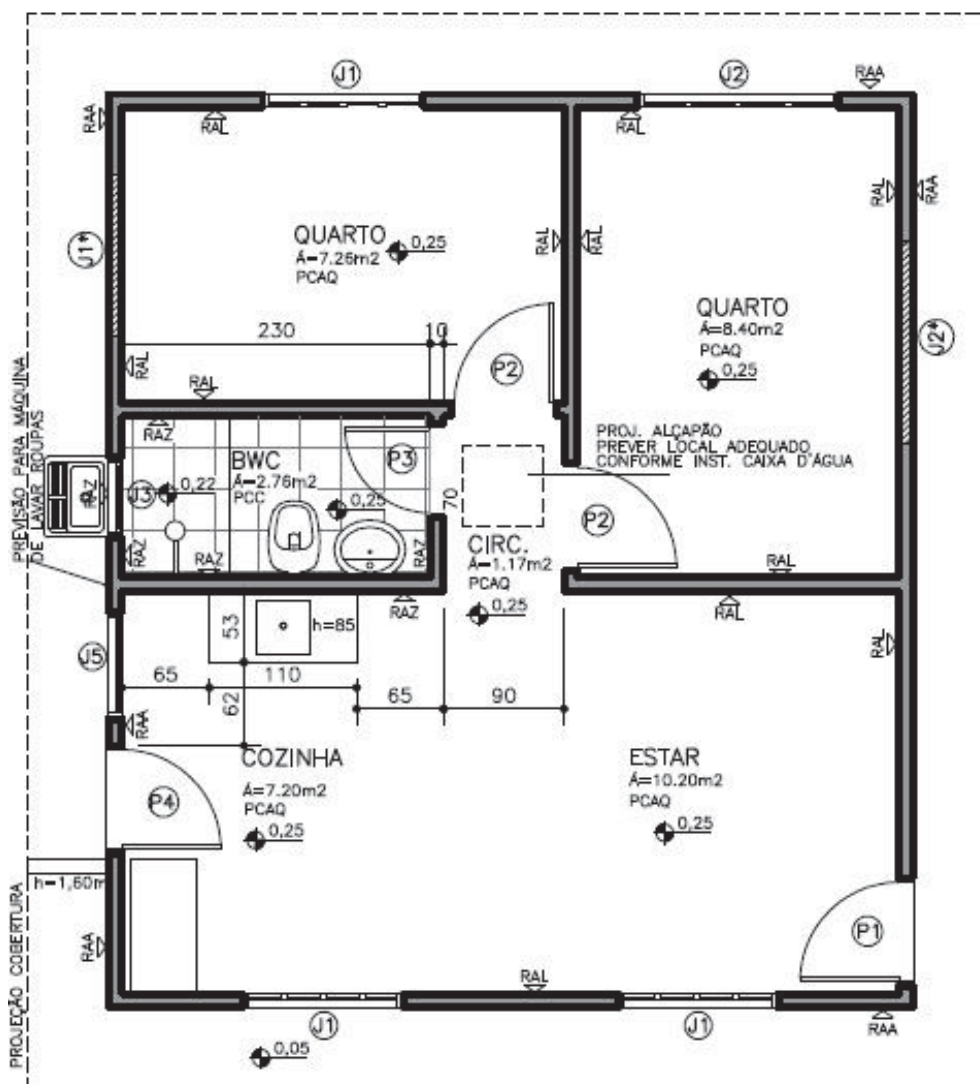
Planta baixa da habitação de interesse social utilizada neste trabalho
